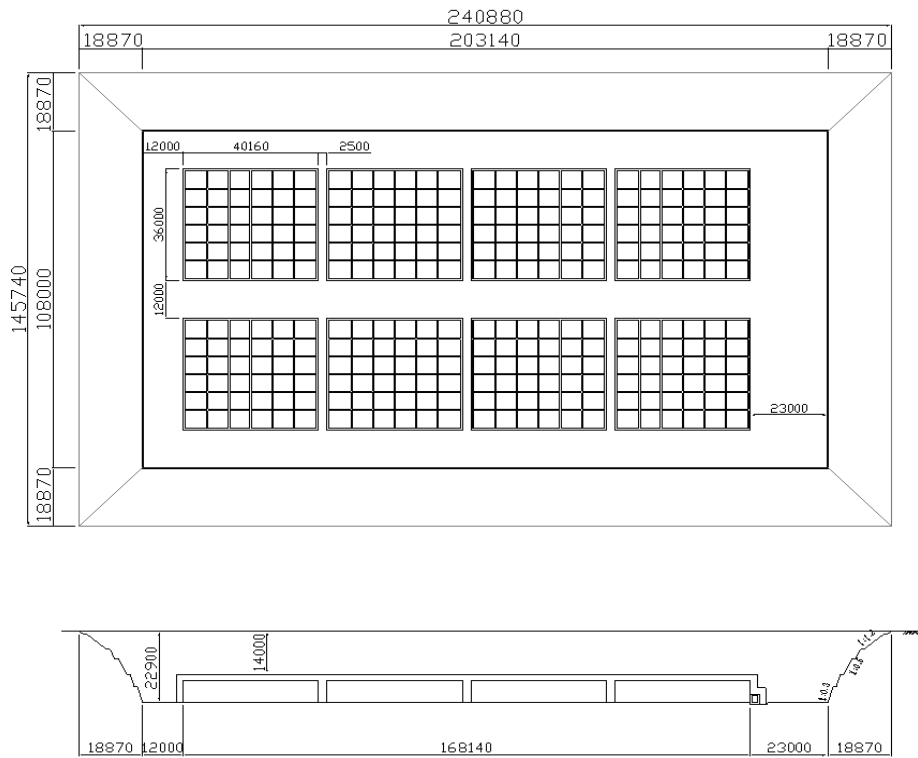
S 埋設地におけるコンクリートピット埋設施設の配置図
